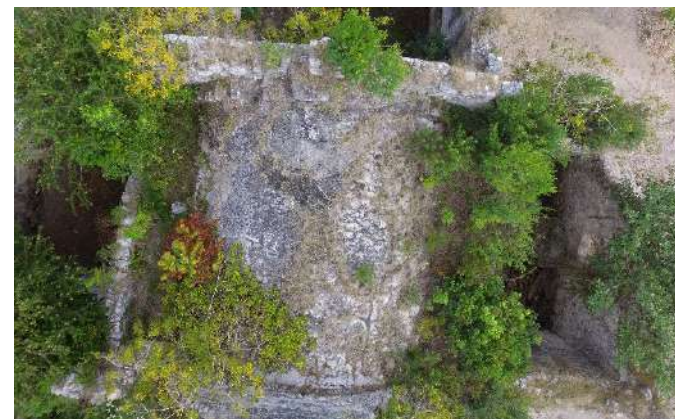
Bóveda de mampostería en presbiterio. Foto: ArqueoDron®, enero 2018
